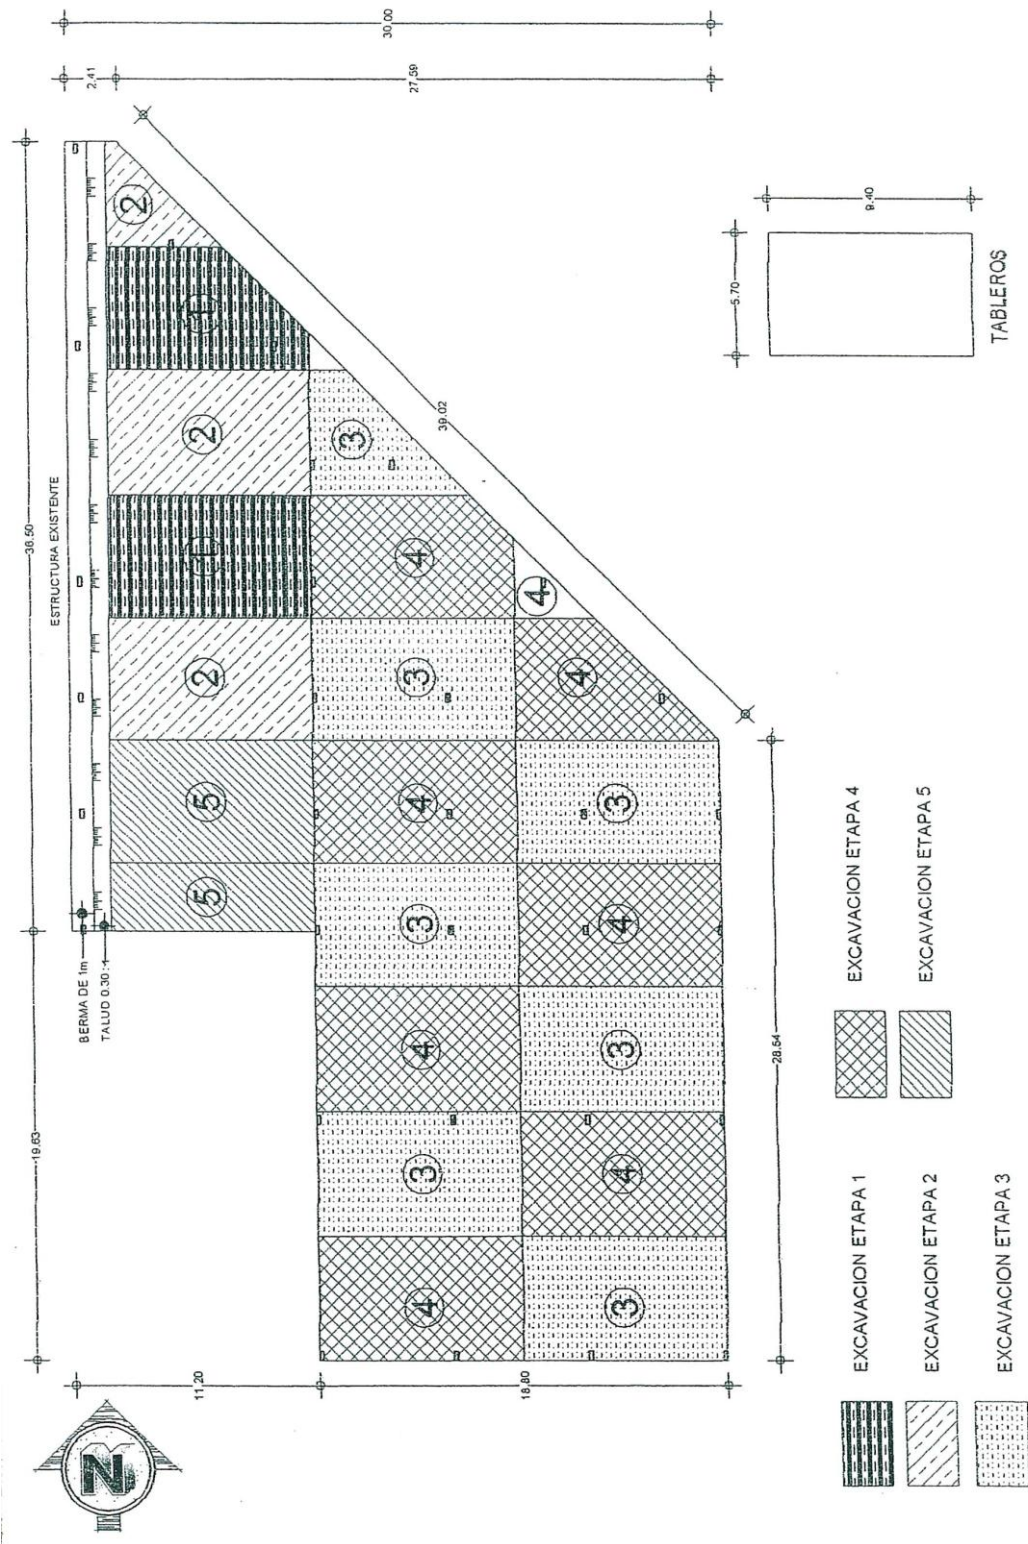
PLANTA DE ETAPAS DE EXCAVACION EXSTRUCTURA I (GOBIERNO)
